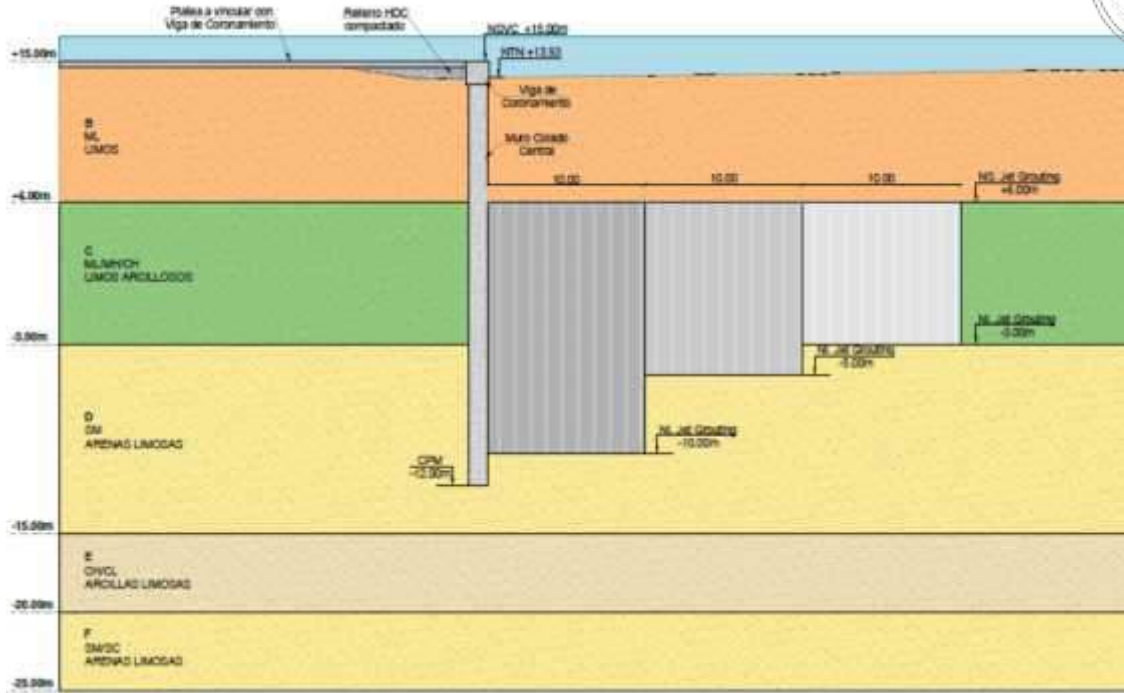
Corte longitudinal de la obra de la pantalla con el suelo mejorado con jet grouting por el eje del cauce
